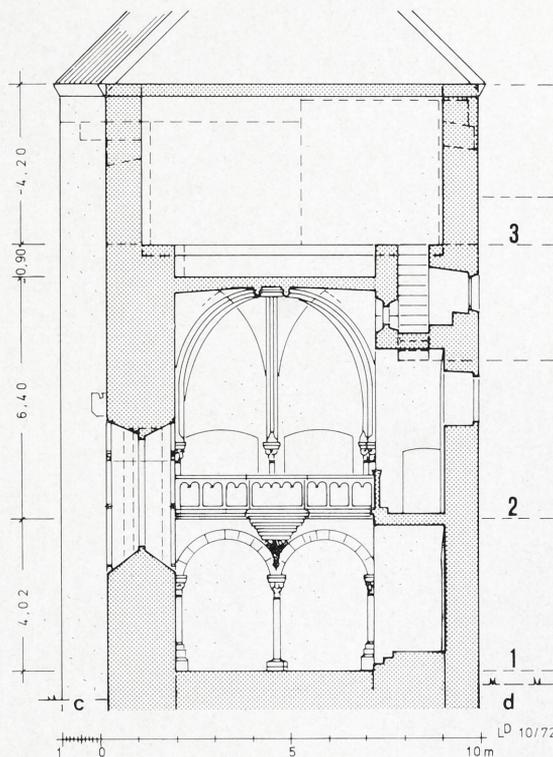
Krautheim a. d. Jagst. Querschnitt durch den Kapellenbau mit Obergeschoßraum (rekonstruiert), Zugangstreppe und Gewölbefenster. (Baufaufnahme und Zeichnung des Verfassers)
